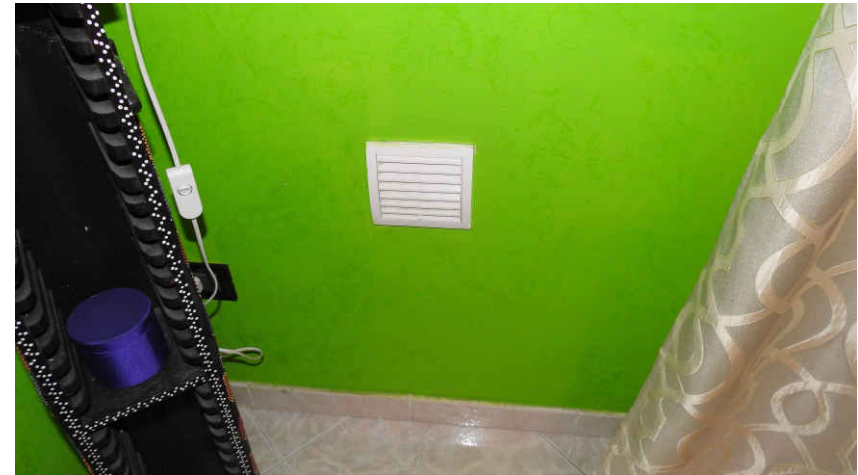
Stanza da letto lato ovest: parte superiore della parete laterale
